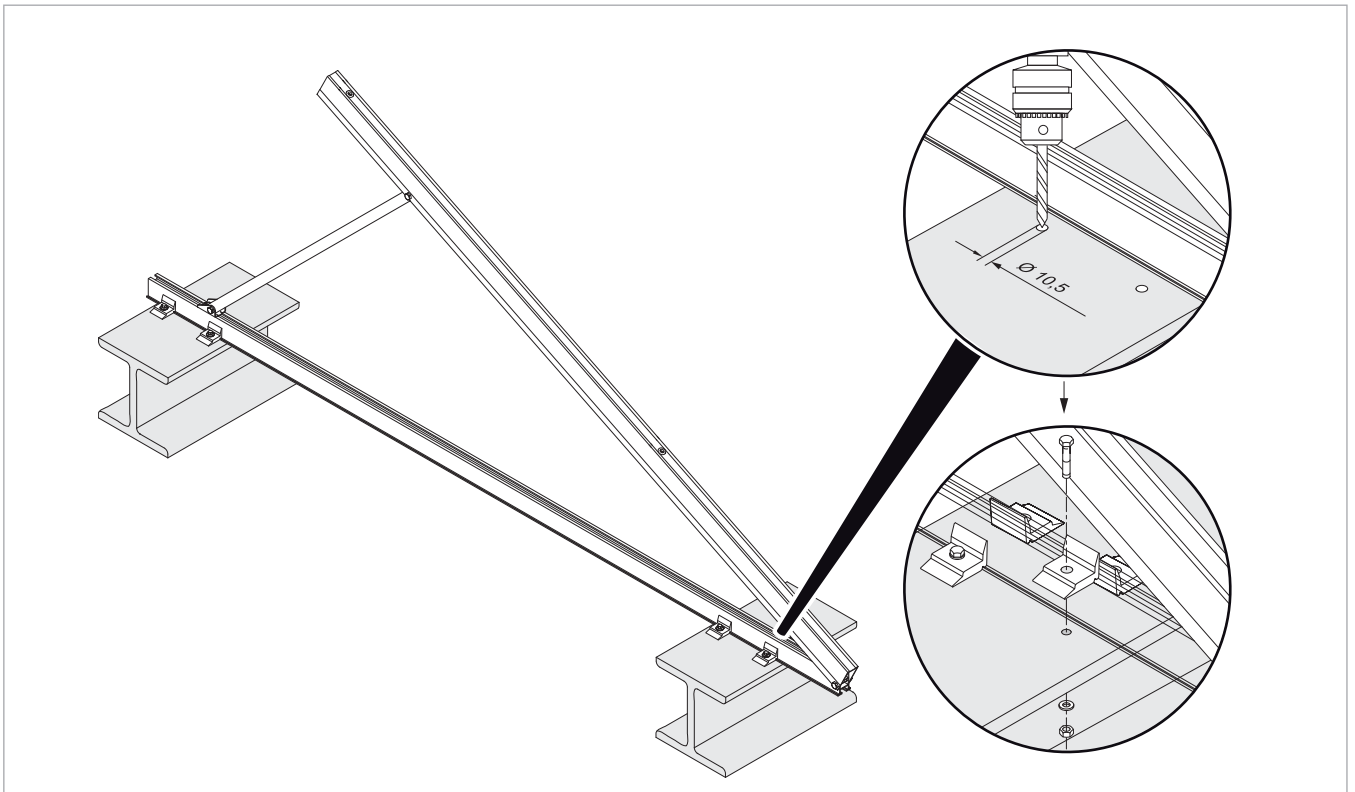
Montaje del soporte para tejado plano en viga de acero
